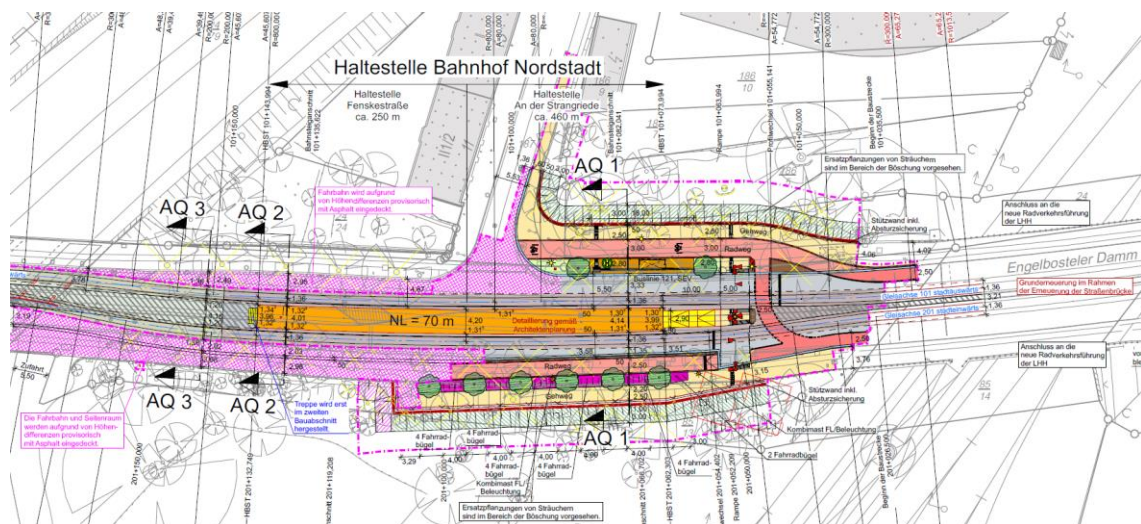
Ausschnitt Lageplan (siehe Unterlage 7: A01\_VA 4 LA 1)
